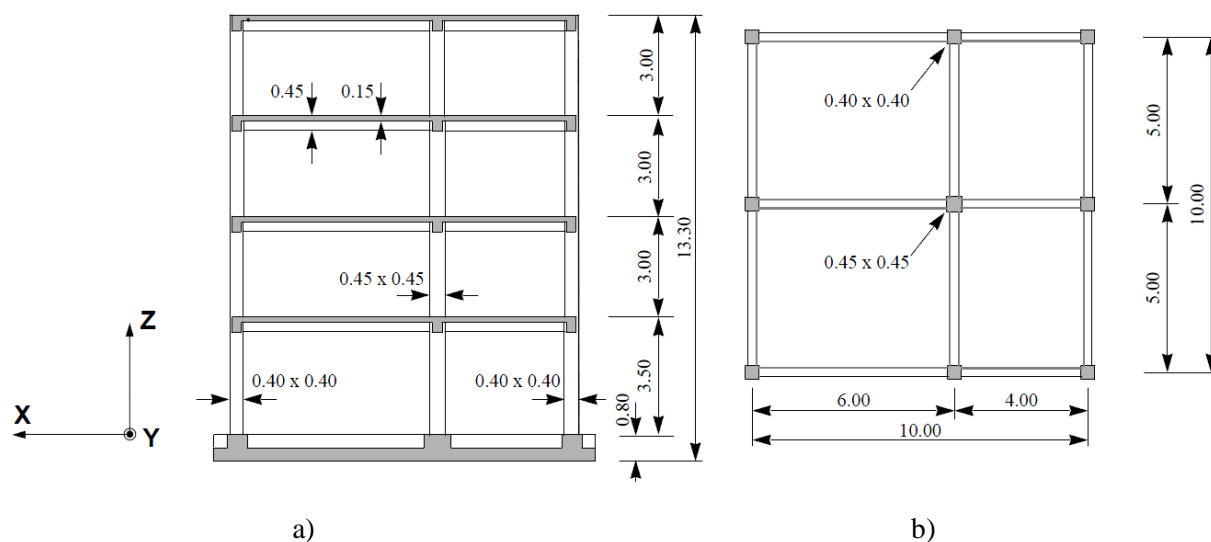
Edifício ELSA Frame: a) Vista em perfil b) disposição em planta (Arêde, 1997)
